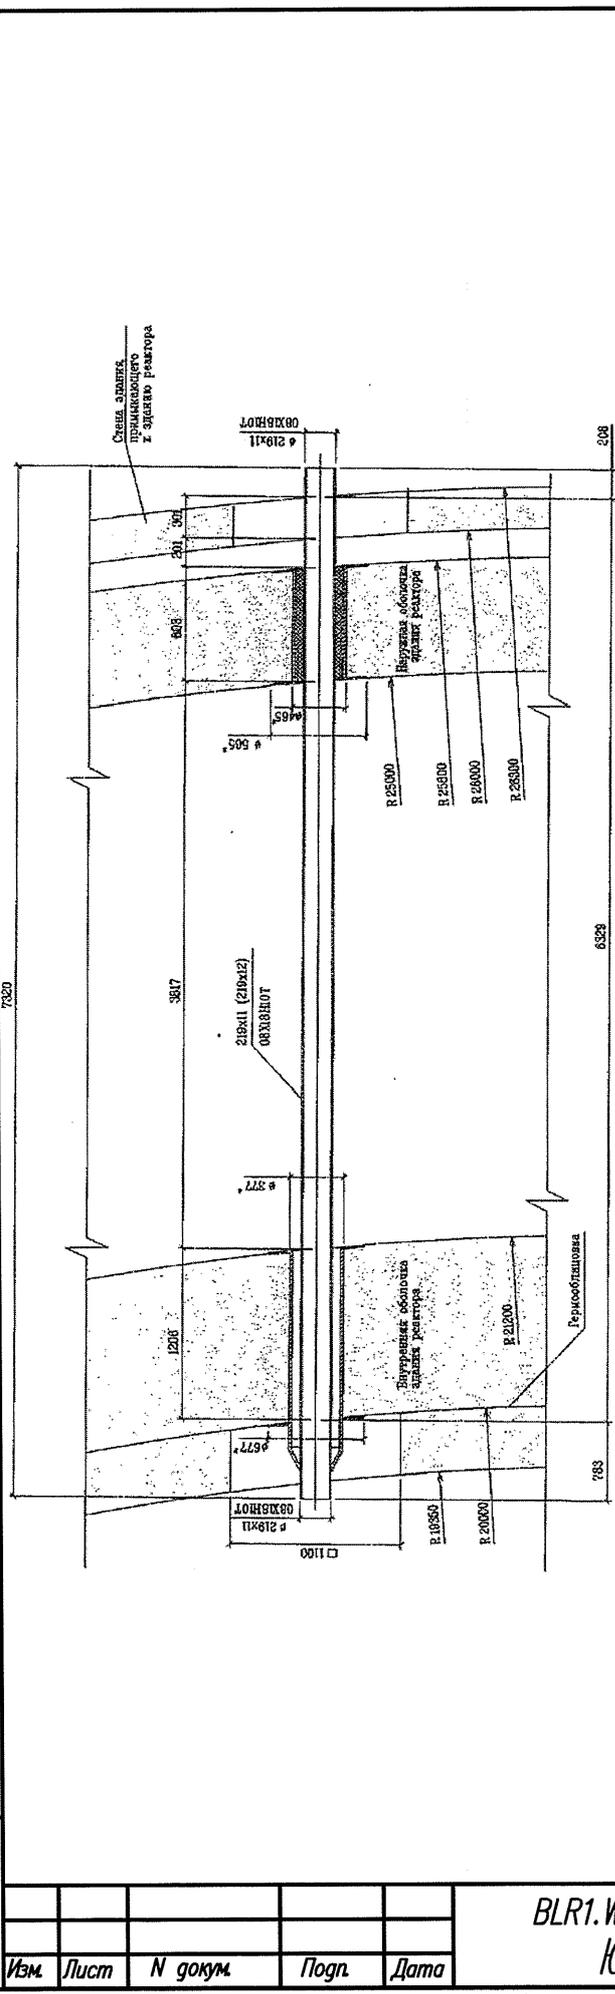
Габаритный чертеж герметичной проходки
